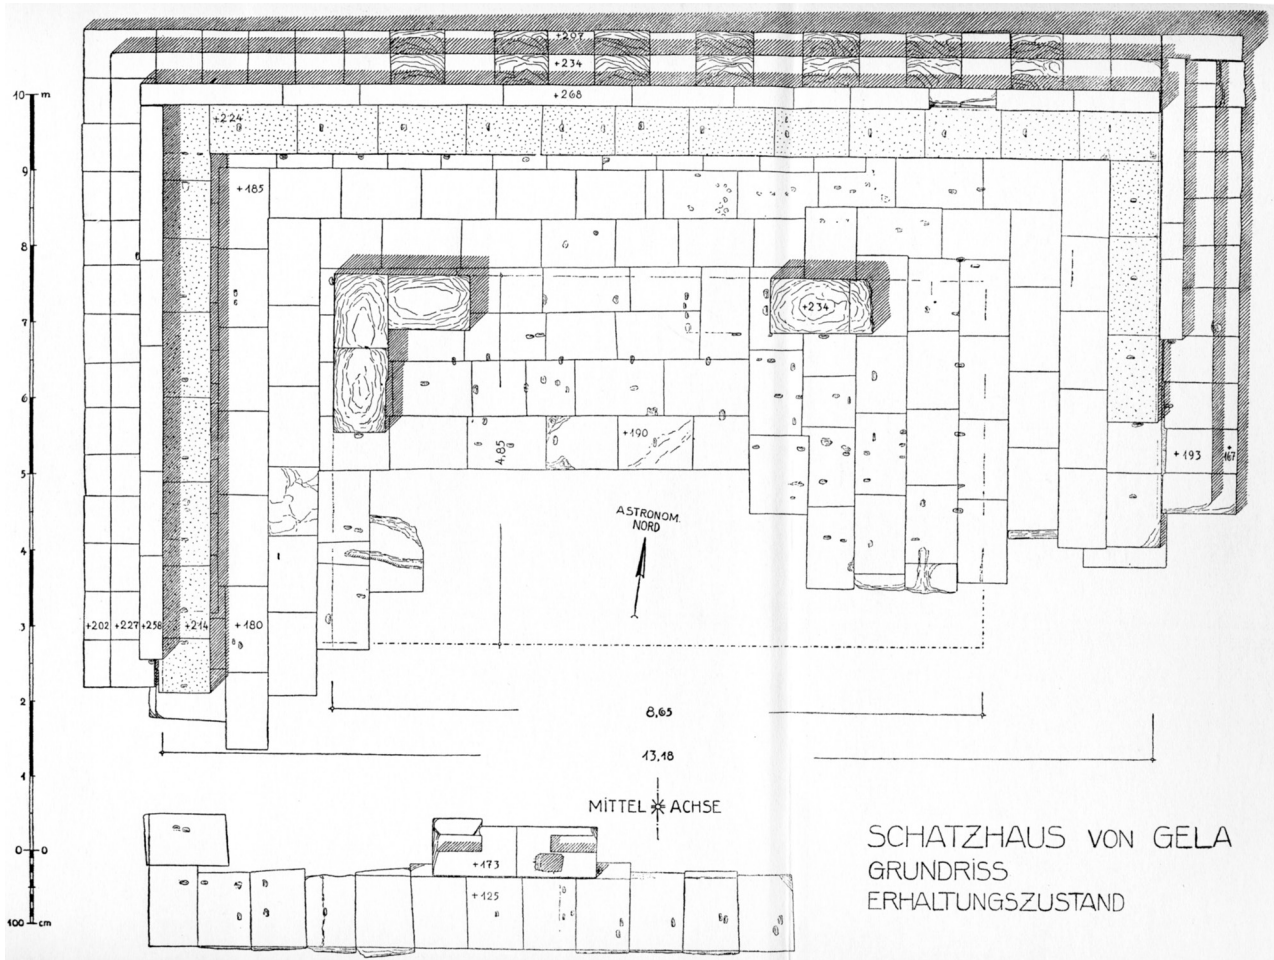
Grundriss des Schatzhauses von Gela (M. 1 : 100)
